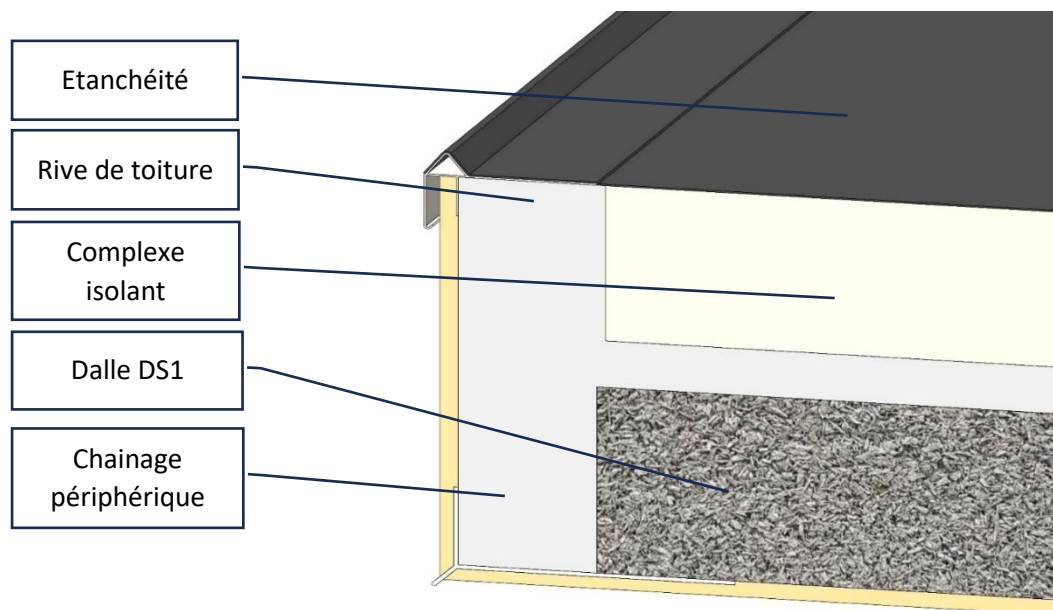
Exemple de traitement d'enduit de façade avec une toiture terrasse DS1
